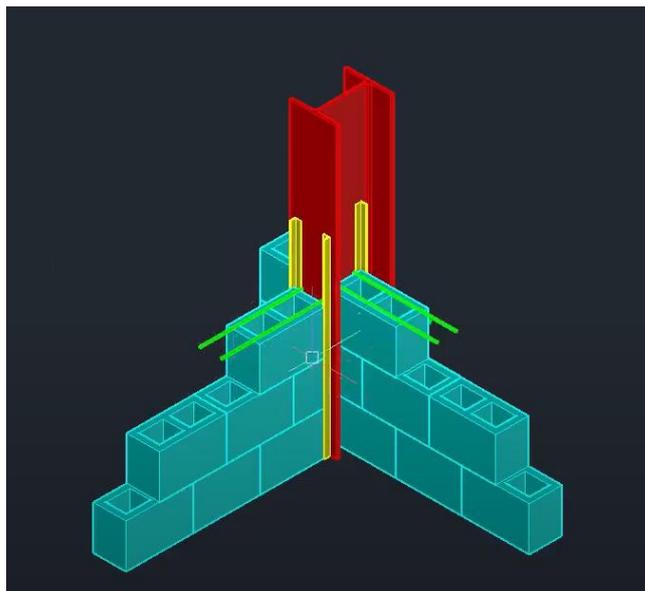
Esquema de ligação da alvenaria à estrutura metálica [52]
